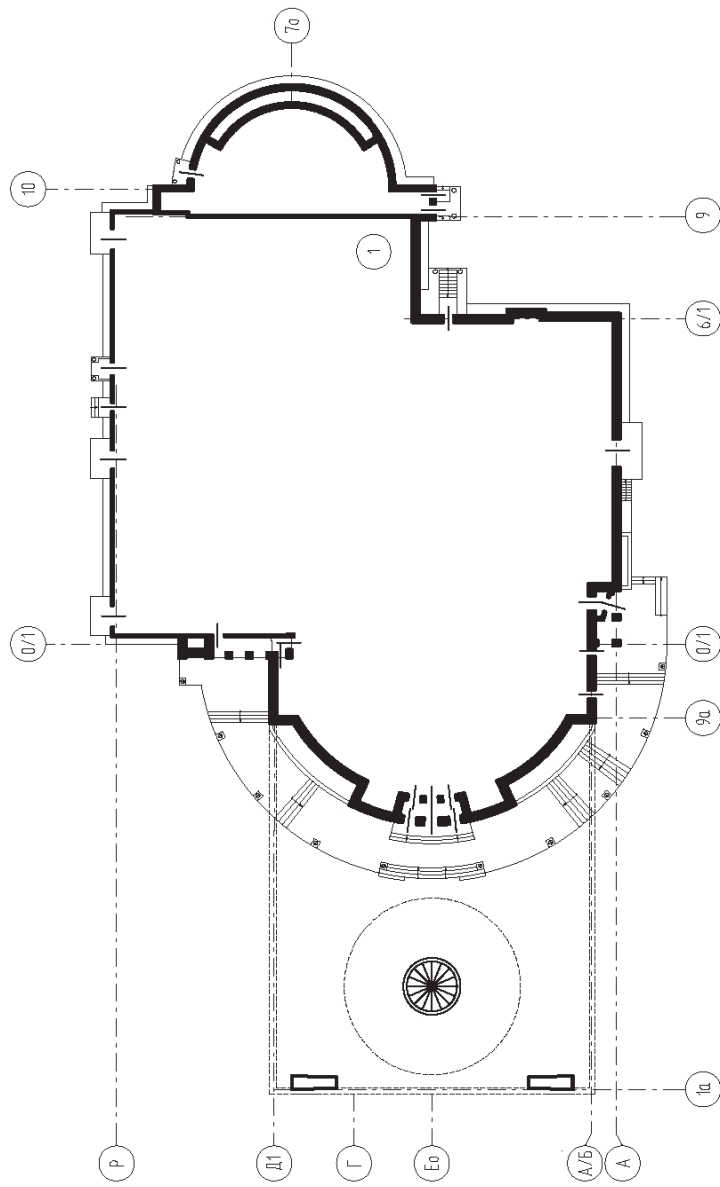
Схема здания в плане. Амфитеатр выполнен способом «стена в грунте». Под фортшахты разрабатываются пионерные траншеи на глубину 1 м. После того как бетон в конструкции «стена в грунте» наберет необходимые прочностные характеристики, разрабатываем основной котлован, ограниченный конструкцией «стены в грунте»
